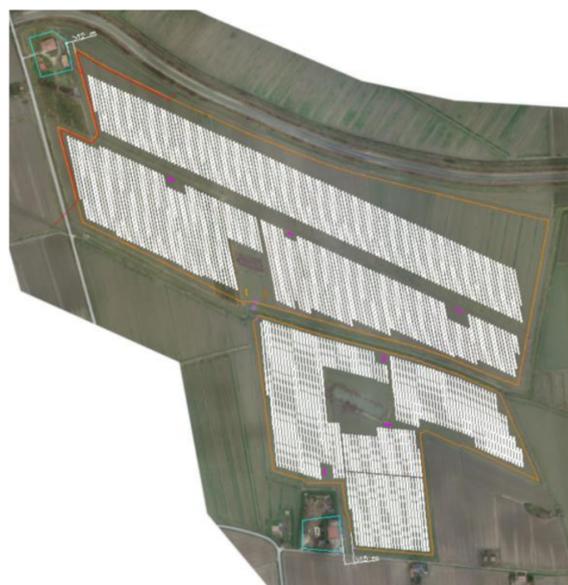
Layout campo Sud dell'impianto fotovoltaico
